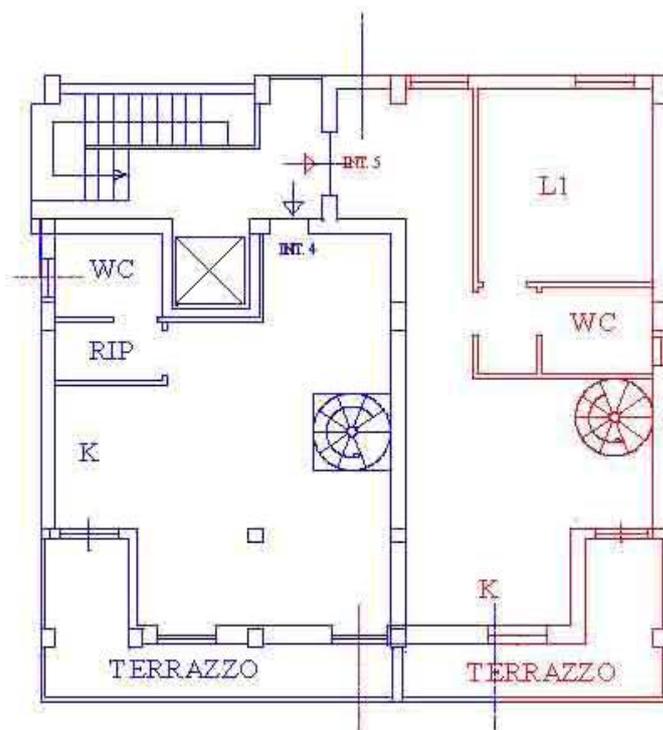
LOTTO N. 3 (GIALLO) E LOTTO N. 4 (ROSSO) AL PIANO SECONDO
